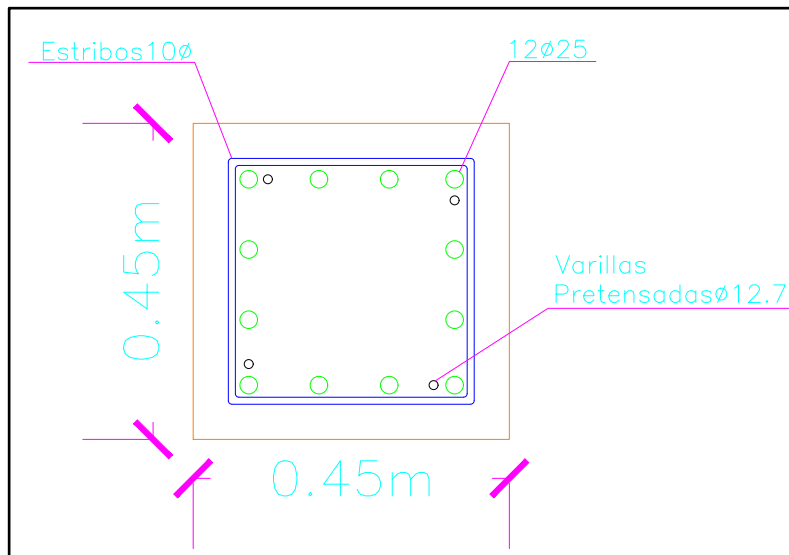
Dimensionamiento del pilote para el muelle secundario. Fuente: Autores
